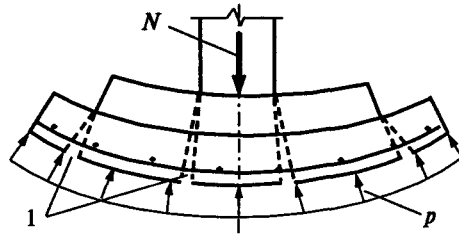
Характер деформации фундамента: 1 – трещины
